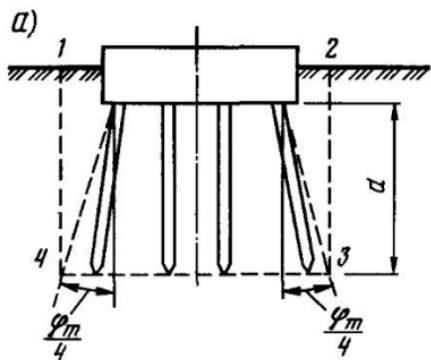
Схемы к проверке несущей способности свайного фундамента как условного фундамента мелкого заложения:
